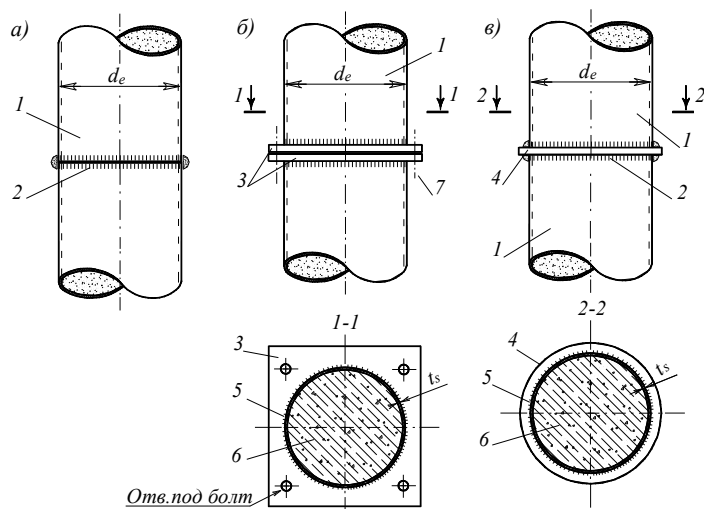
Некоторые типы стыков центрально сжатых трубобетонных элементов: а – "сухой" стык впритык; б – фланцевый стык; в – стык через металлическую прокладку; 1 – трубобетонный элемент; 2 – сварочный шов; 3 – соединительные фланцы; 4 – металлическая соединительная прокладка; 5 – стальная труба; 6 – бетонное ядро; 7 – ось отверстия
